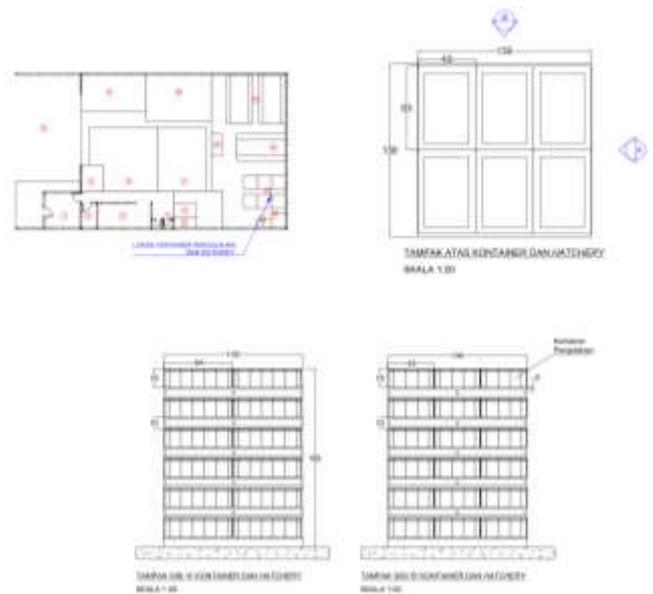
Denah Rencana TPS 3R Sawunggaling
